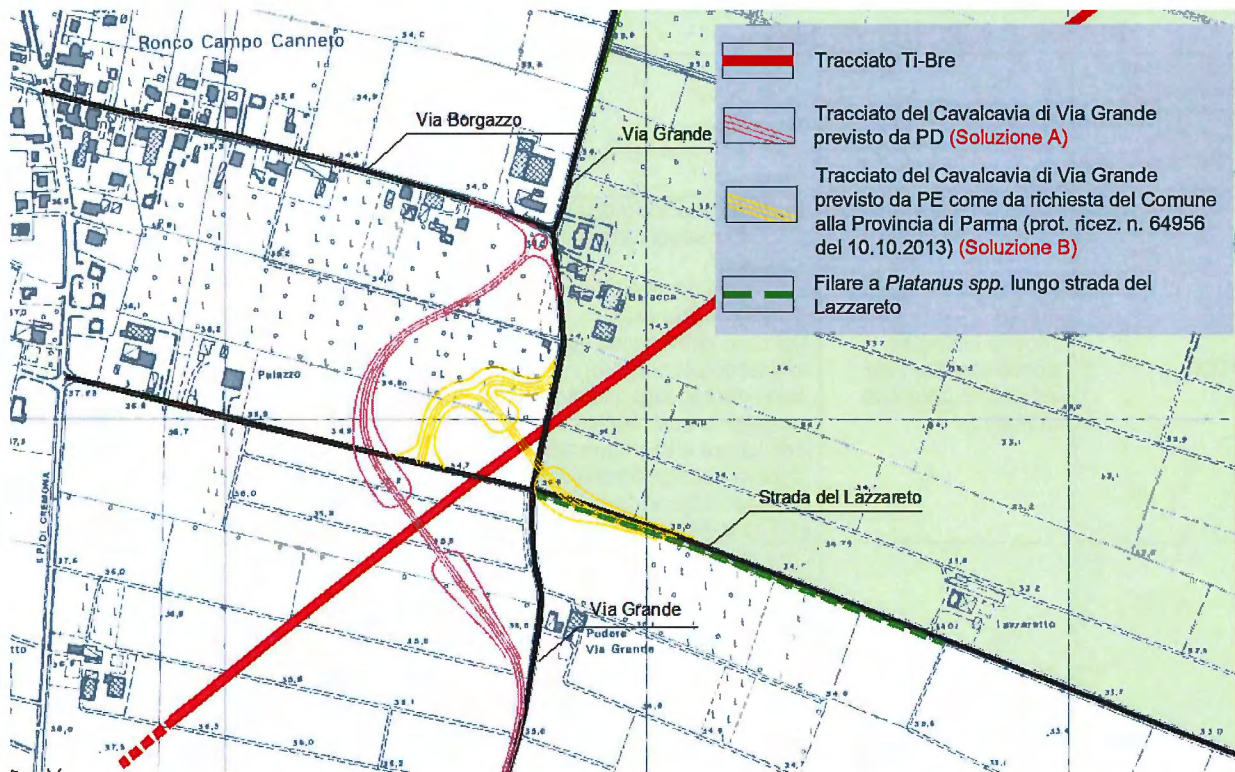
Rappresentazione schematica dell'ubicazione del Cavalcavia di Via Grande come prevista dal Progetto Definitivo (in rosa) e dal Progetto Esecutivo (in giallo).
